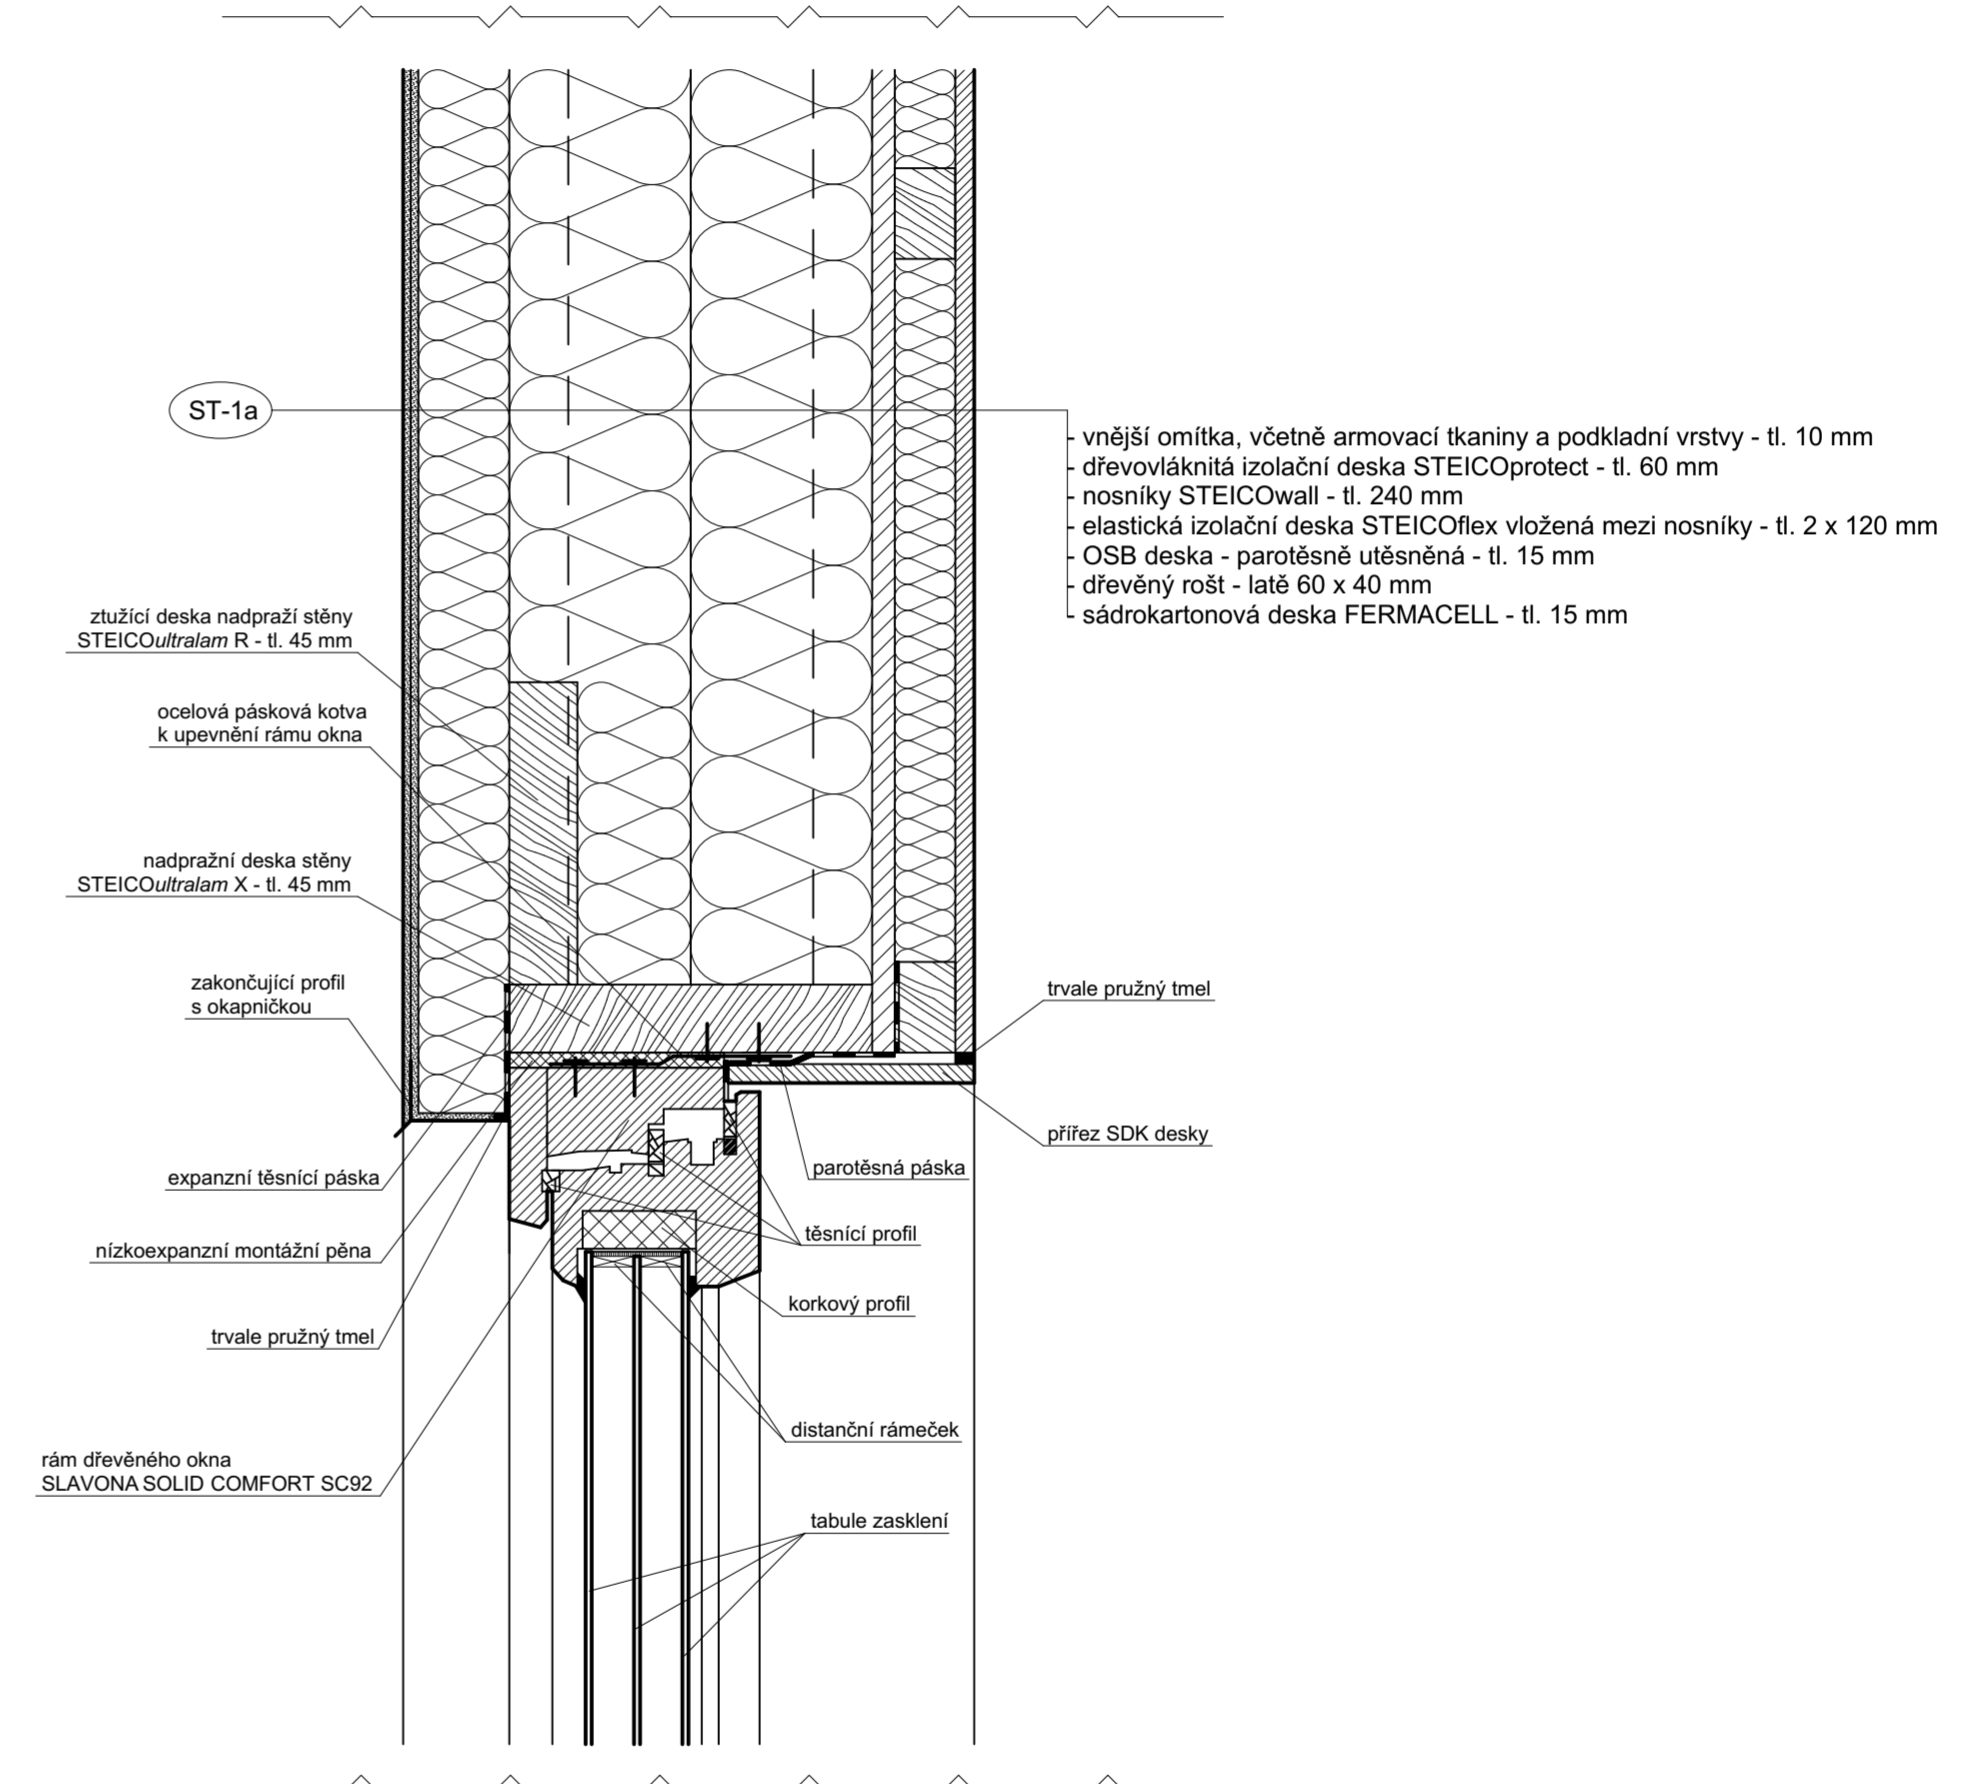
DETAIL E - PARAPET A NADPRAŽÍ OKNA VE STĚNĚ ST-1a
